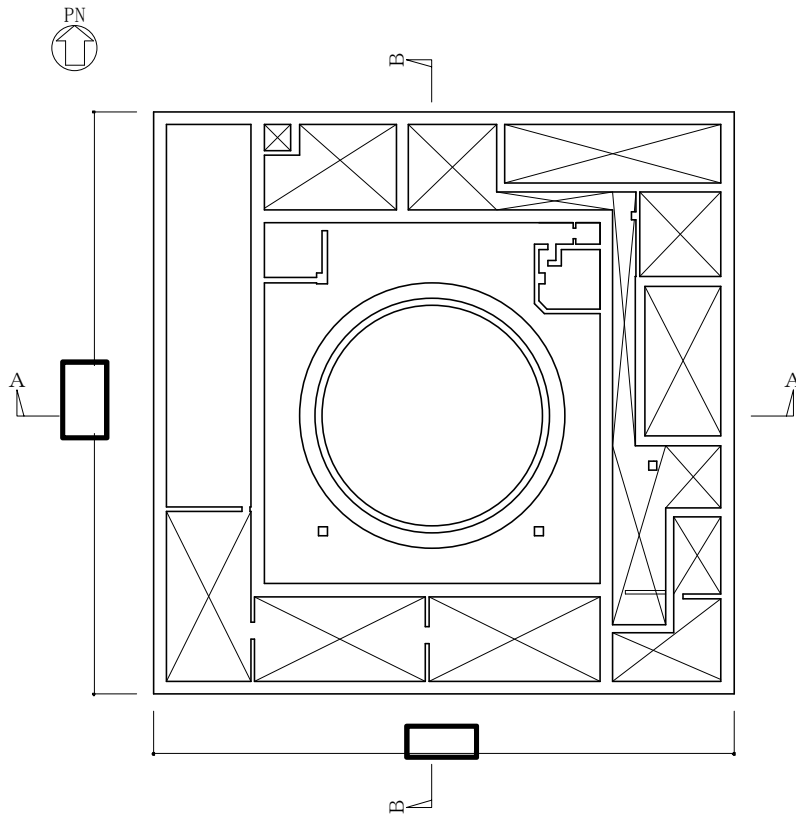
(2/9)  の概略平面図 (EL. 2.0 m)
